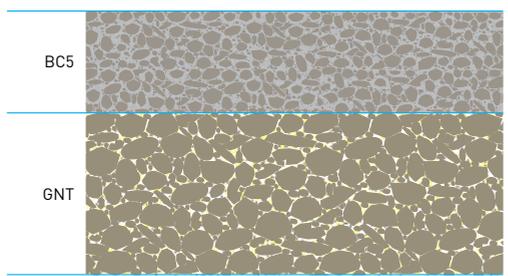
Coupe en travers-type en béton BC5/GNT/Support
